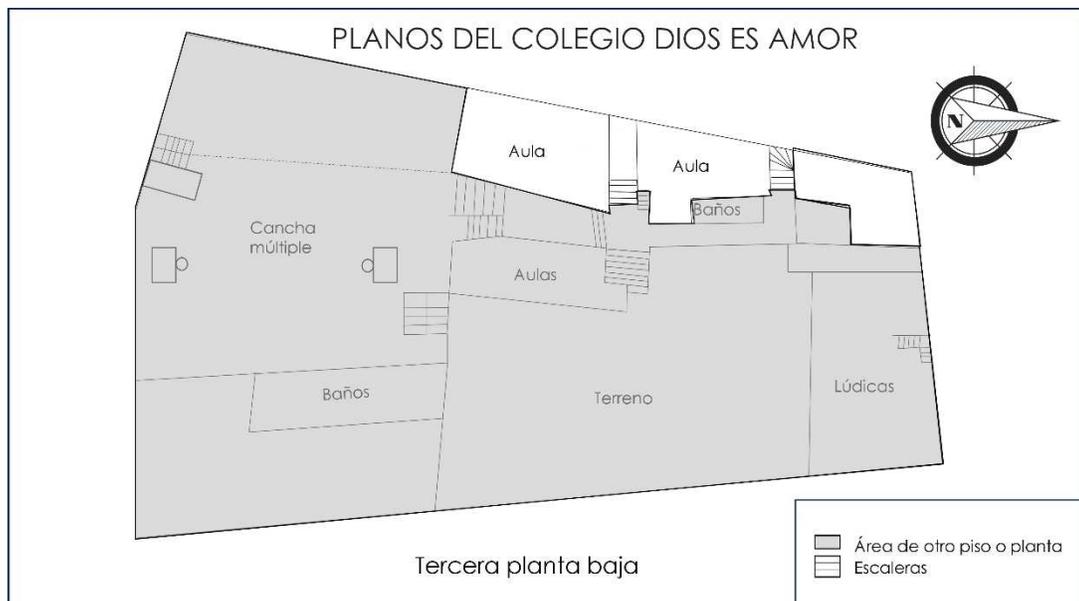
Plano 4: Tercera planta baja. Fuente: IEEE, 2017.
